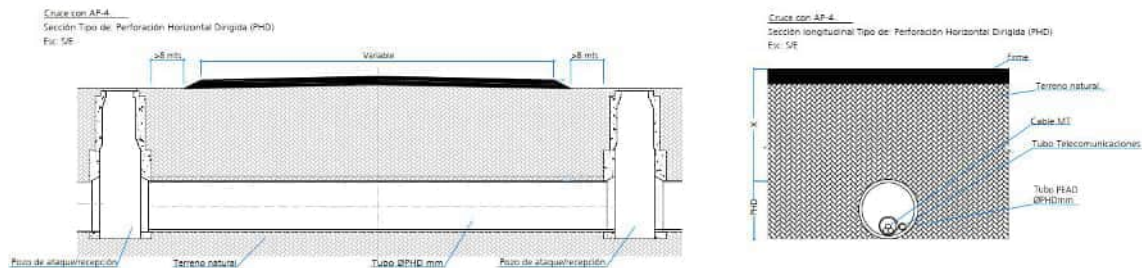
Perforación horizontal dirigida. Fuente: Elaboración Propia.
